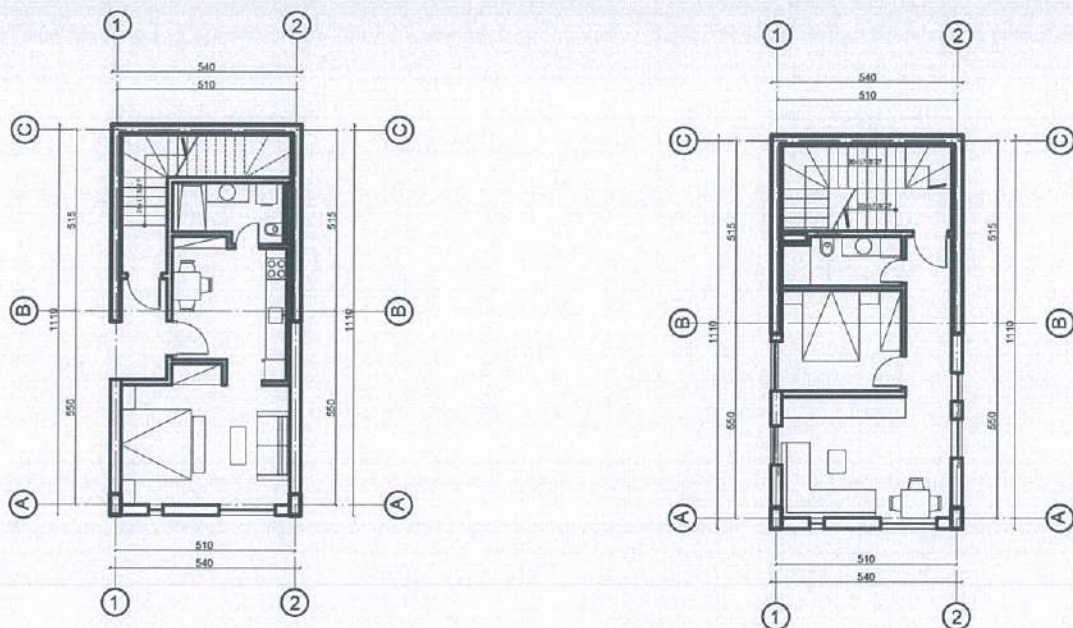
Planimetri e nivelit 1 dhe 2 te vilës
